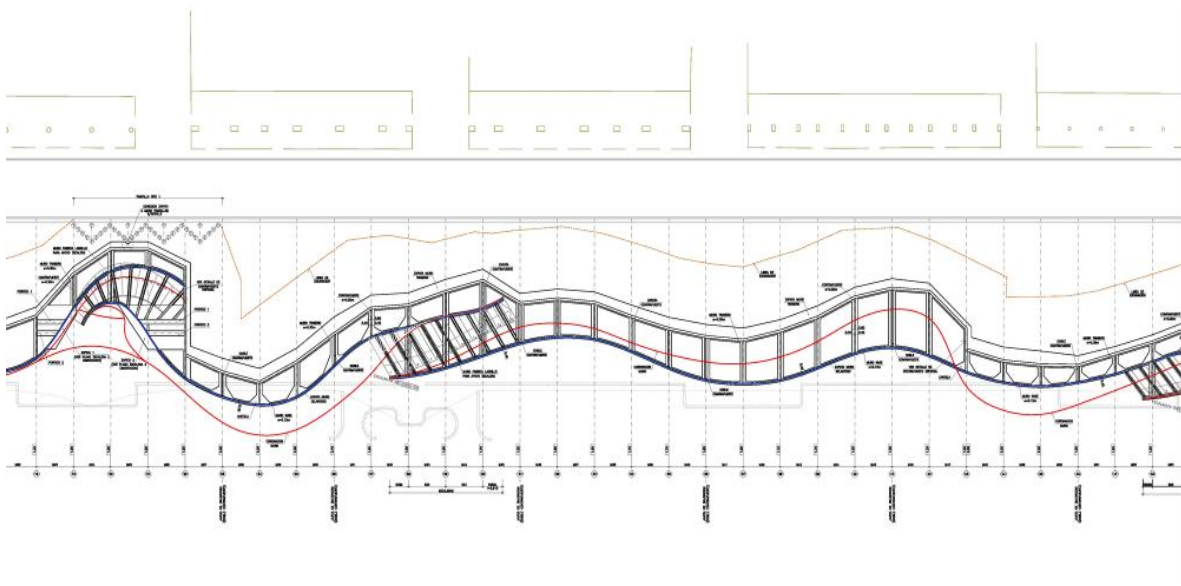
Planta Arquitectónica de Proyecto “Paseo Marítimo de Benidorm”
